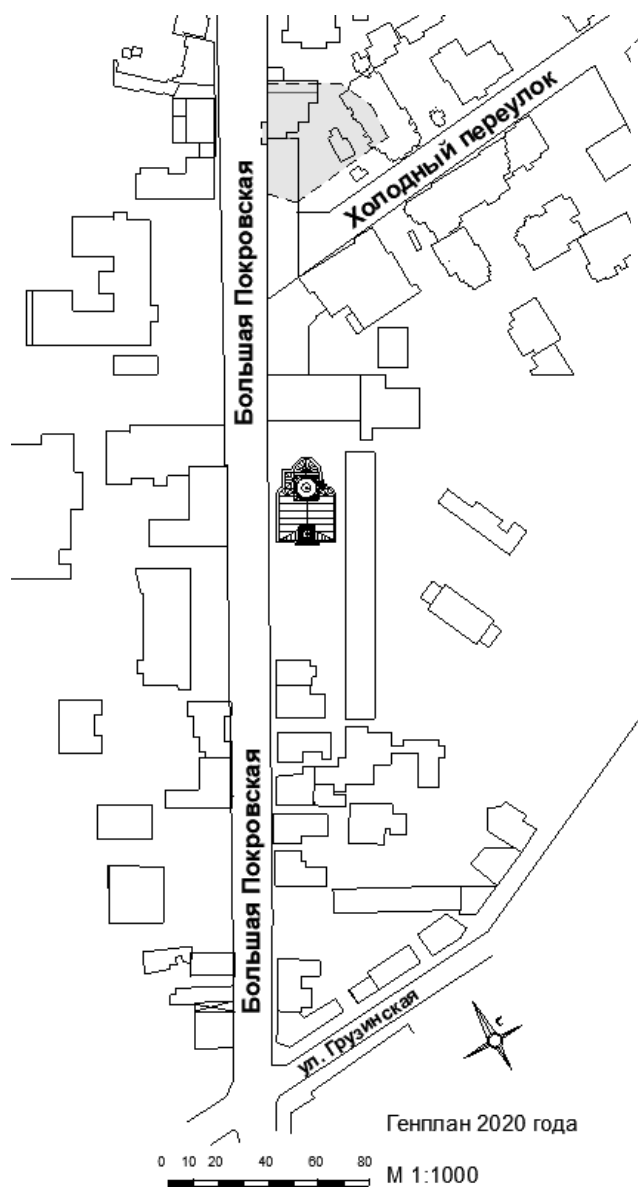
Генплан участка ул. Б. Покровской с воссозданием церкви Покрова Пресвятой Богородицы на новом месте, на момент 2020 г.
